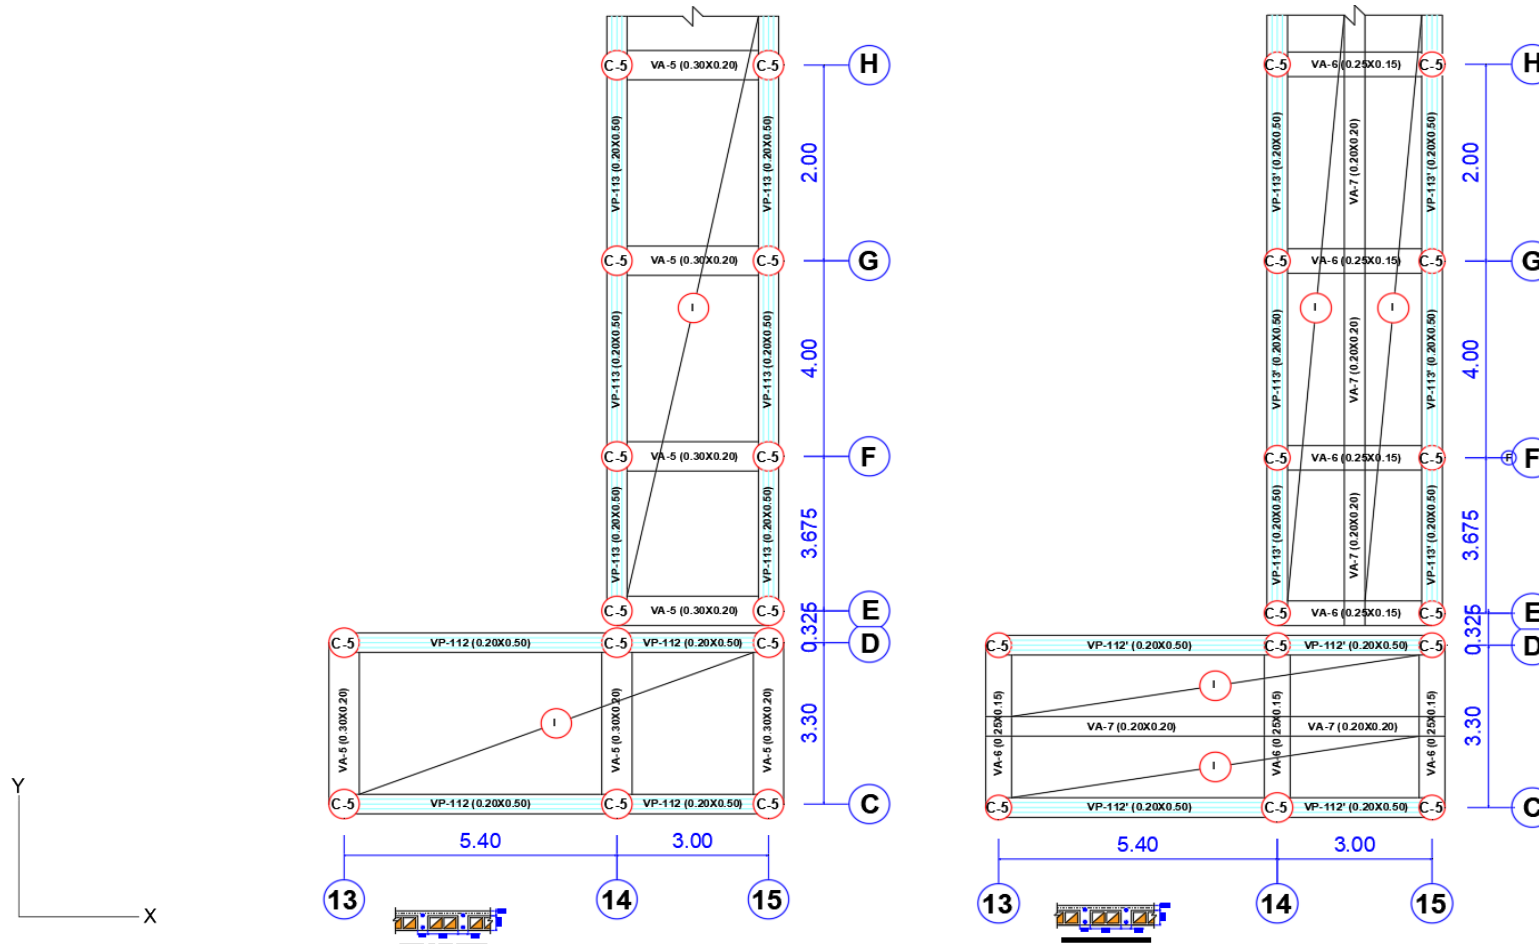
Distribución de los elementos estructurales del Primer Nivel y Segundo Nivel (Fuente: Archivos del Área de Archivo Central, de las obras ejecutadas en la Universidad Nacional de San Martín – Tarapoto)
